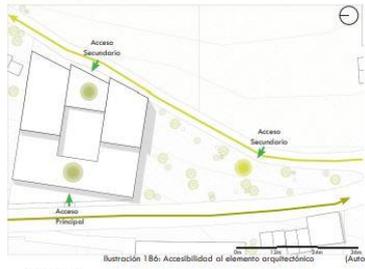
Accesibilidad al elemento arquitectónico. (Autor)
